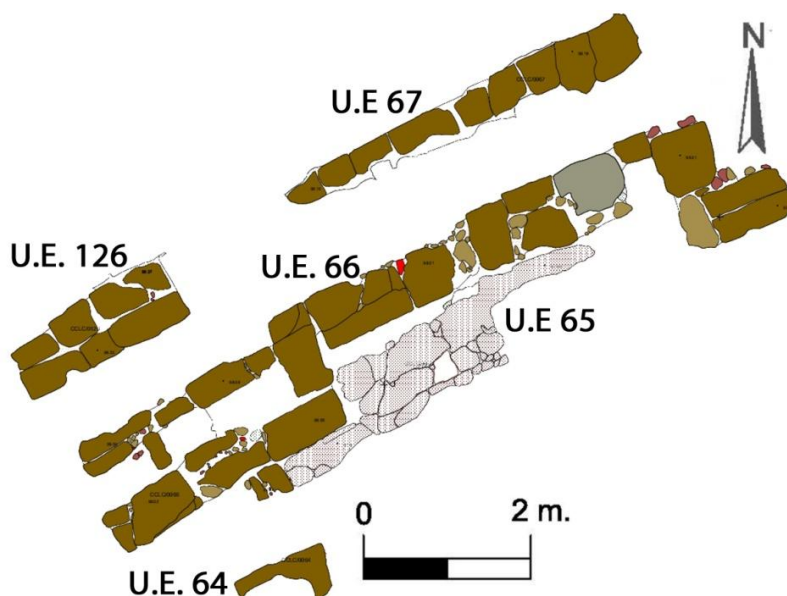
C. Corregidor Luis de la Cerda: planta de la construcción exhumada en el extremo noroeste de la calle. Modificado a partir de PIZARRO, 2008, plano 6.0.
